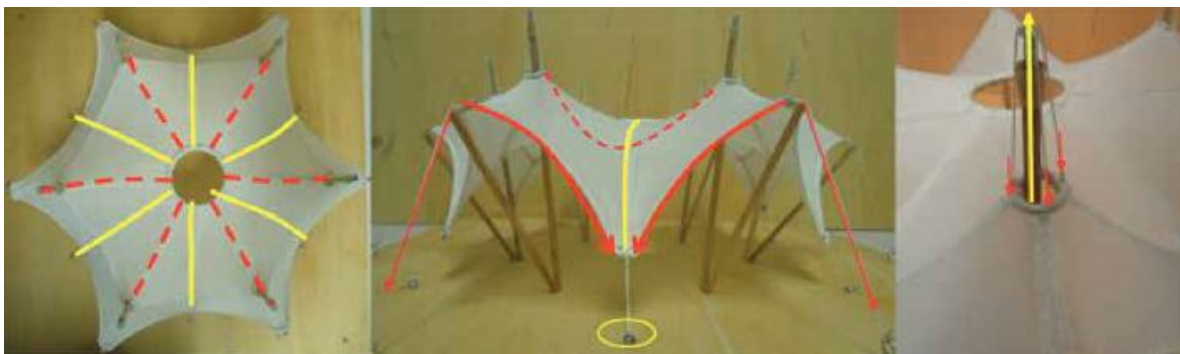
a la 13. En nuestra experimentación podemos observar que las fuerzas de tracción (línea punteada roja) y las fuerzas de compresión (línea amarilla) actúan en conjunto sobre la superficie de la membrana por la acción de fuerzas de compresión de los anillos de compresión. También observamos que las relingas se encuentran totalmente tensionadas por un cable que las hala hacia la superficie (flecha roja) y que además trabaja en conjunto con el mástil inclinado de la estructura. En cuanto a los mástiles de los puntos altos actúan con un esfuerzo puntual los anillos actúan a compresión.
